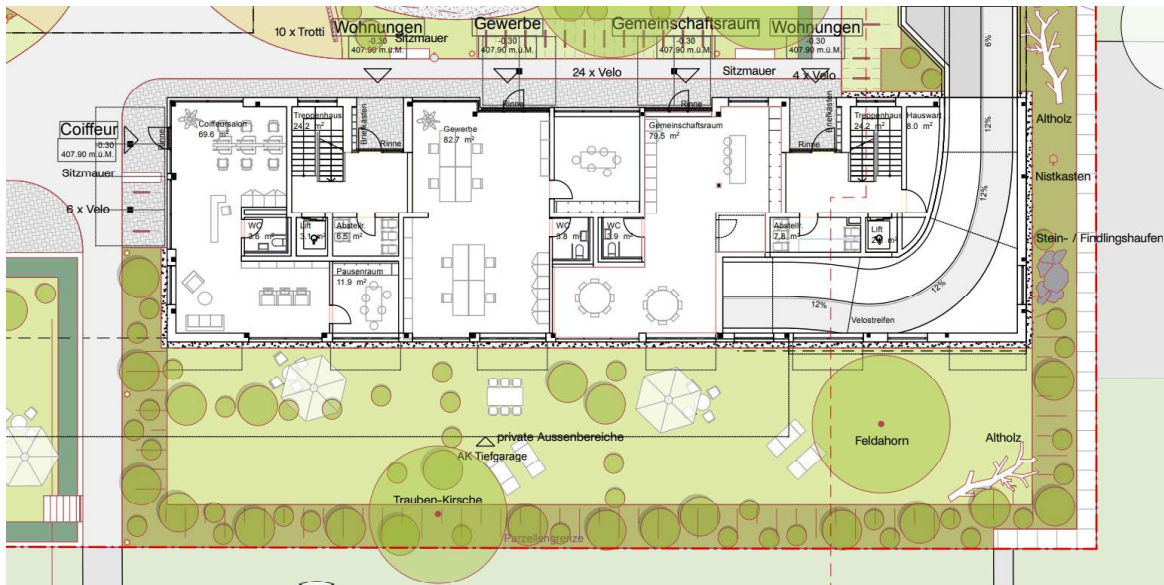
Bereich private Aussenbereiche südlich Haus C (Quelle: BÖE studio, 2025)
